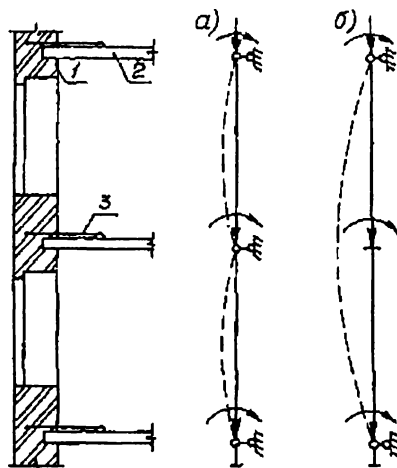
Расчетная схема несущей каменной стены многоэтажного здания
